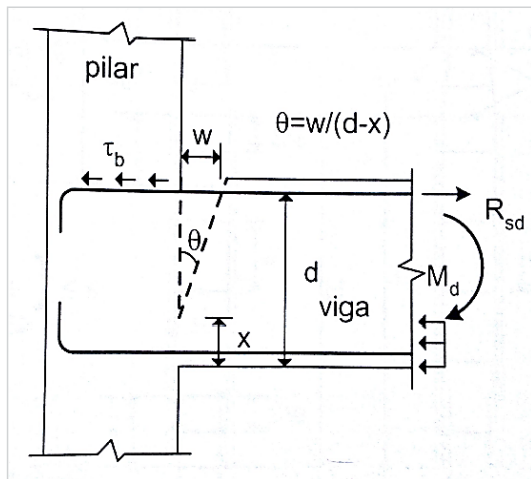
Rotação adicional nos nós de pórtico de concreto armado
